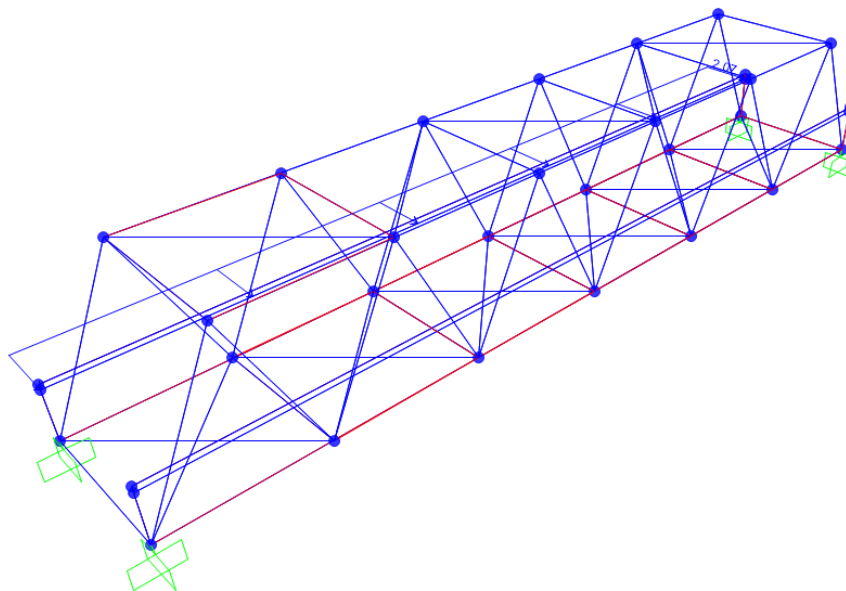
Aplicación de cargas de viento empuje horizontal negativo.
